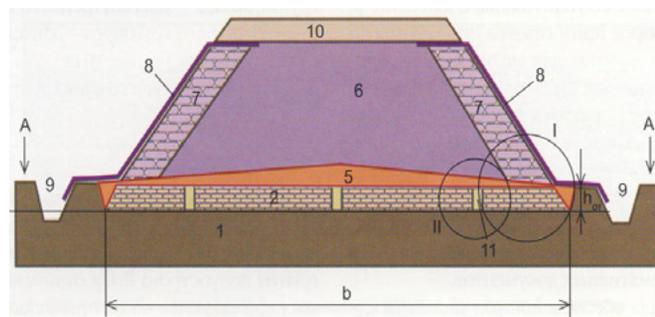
Конструктивная схема заглубленной многослойной насыпи на мерзлом грунте: 1 – мерзлое основание; 2 – траншея; 5 – теплоизоляционный слой; 6 – тело насыпи из некондиционного высокольдистого грунта; 7 – откосы из непроницаемых объемных элементов; 8 – нефильтрующие геополотница; 9 – дренажные каналы; 10 – дренажный слой; 11 – вентиляционные щели.
